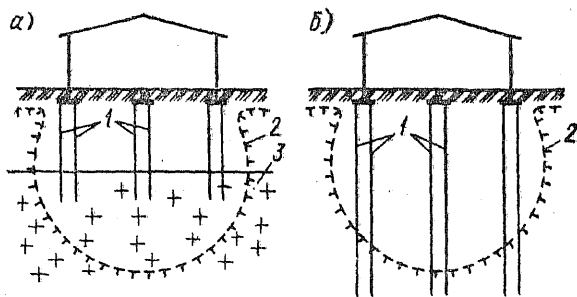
Схемы свайных фундаментов при проектировании и строительстве по принципу II
